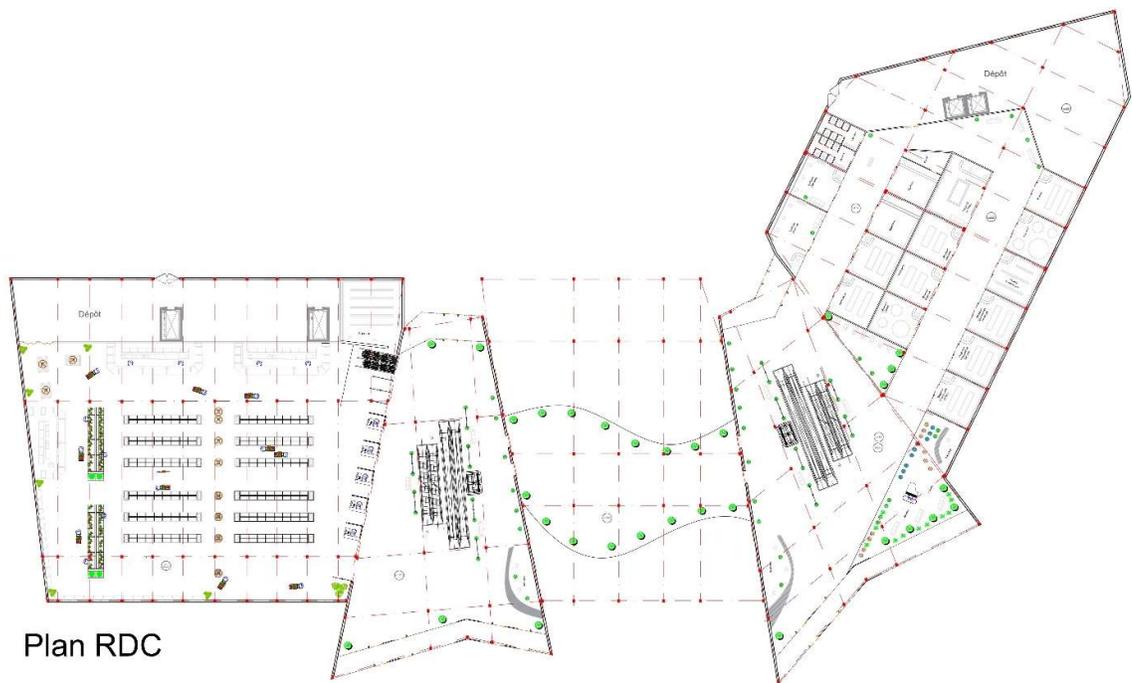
Plan 02: Plan d'ensemble (l'auteur 2020)
